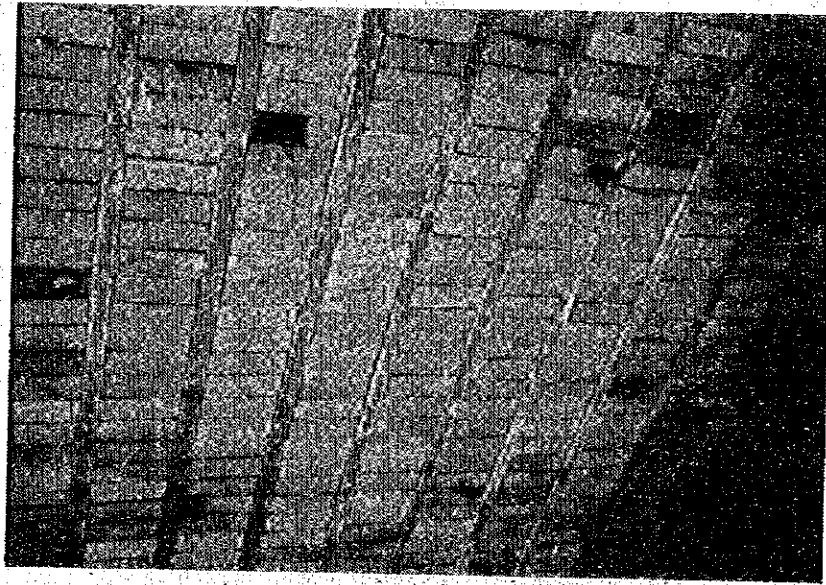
Beaucoup de planchers sont composés de parparing en béton (ou de briques) maintenus par des joints en béton armé (ou en armature de fer) et recouverts de ciment (ou de mortier). Leur poids les rendant souvent fragiles.
